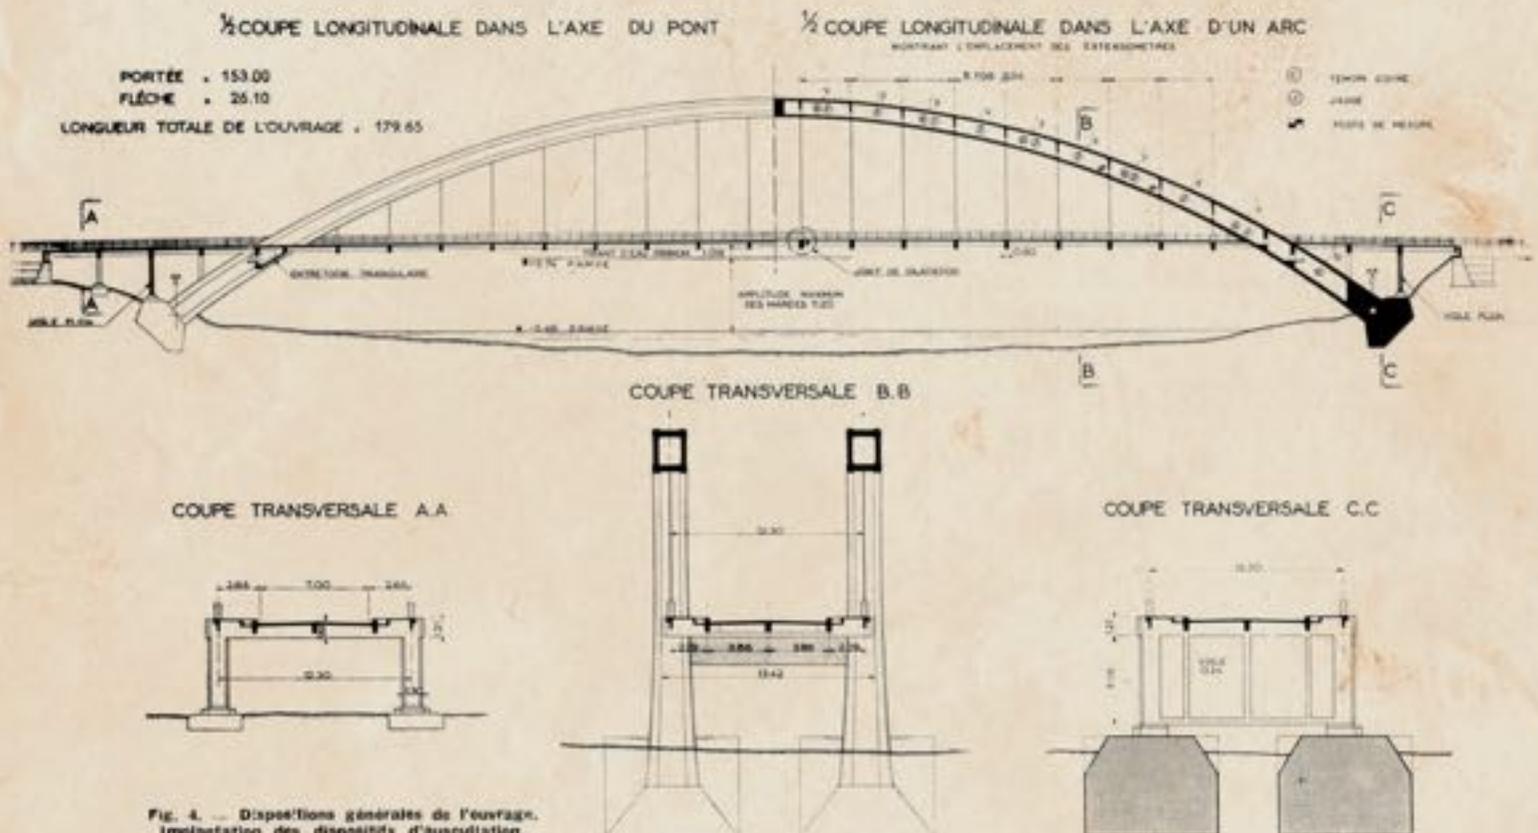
Dispositions générales de l'ouvrage. Implantation des dispositifs d'auscultation.
